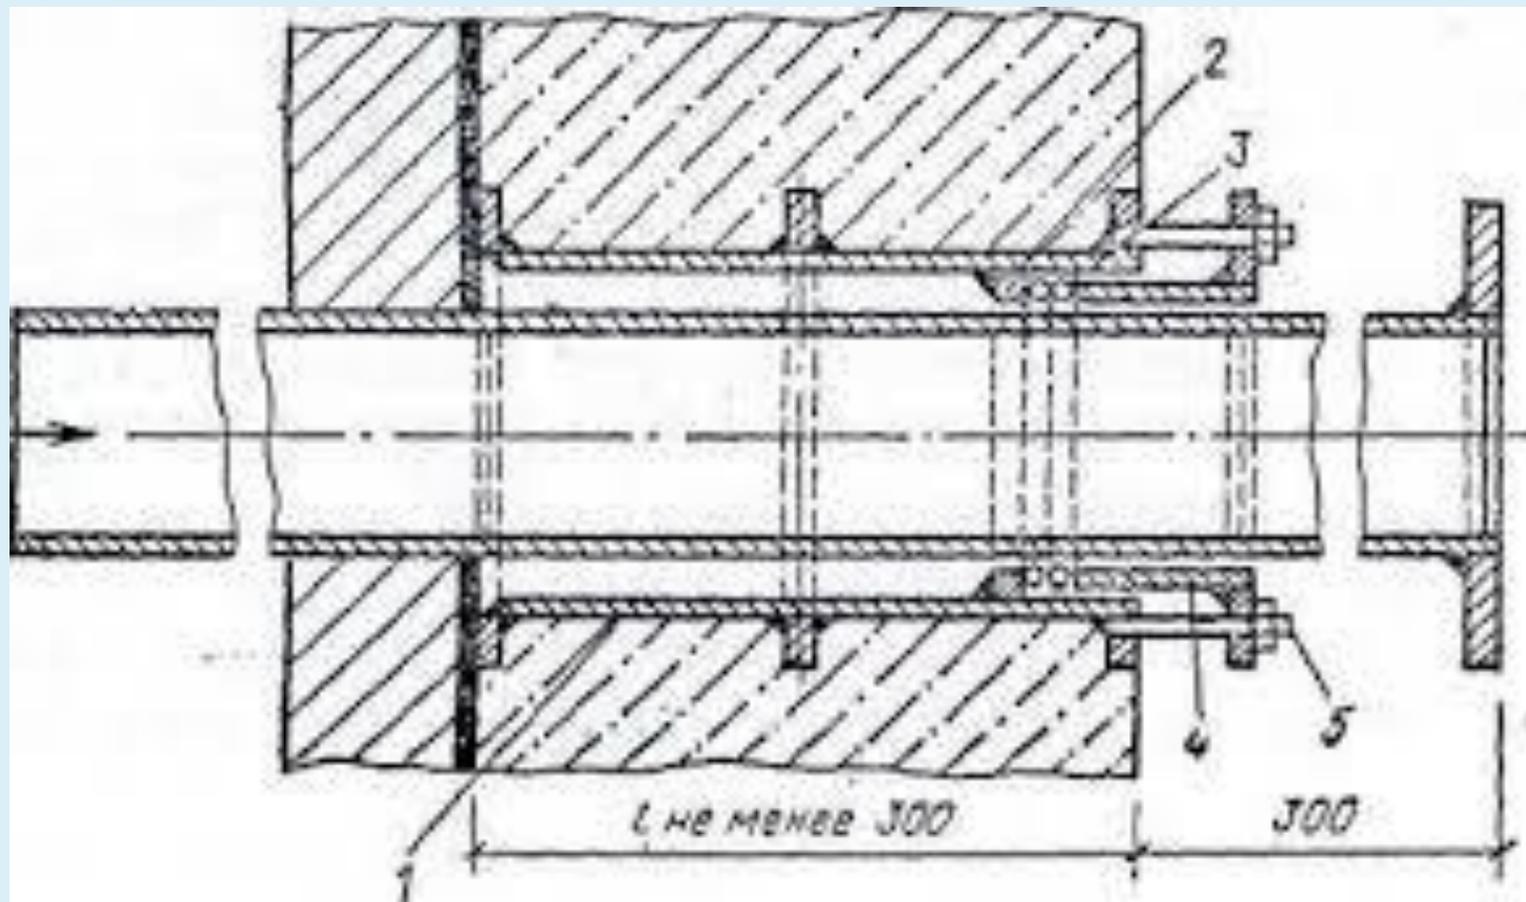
Ввод водопровода через стену подвала (фундамент) при наличии грунтовых вод...
